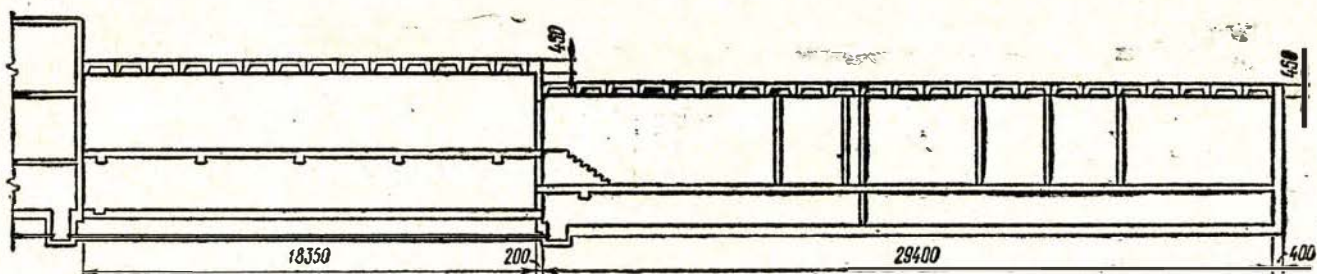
Подстанция монолитно-сборной железобетонной конструкции
